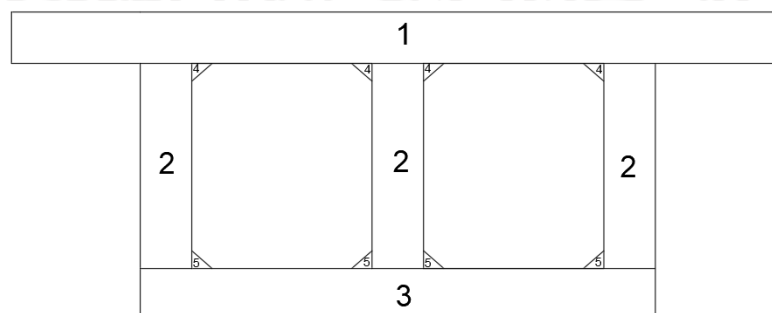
Properties *Box Girder* Penampang Trapesium
